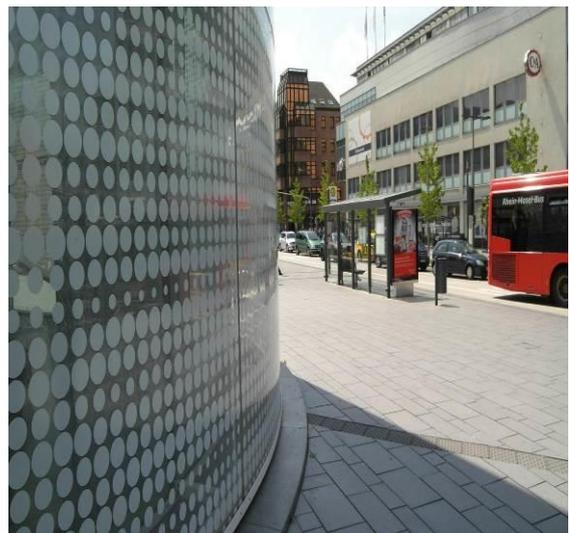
Außenansicht Fassade, Detail Punktraster.
